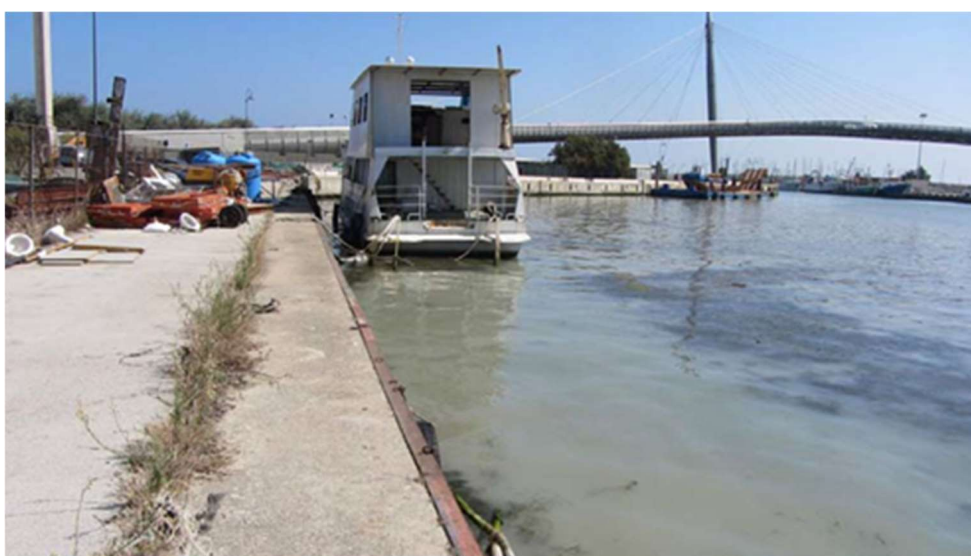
Banchina a perimetro NW area d'intervento. Bassi fondali, ormeggi per disarmo
